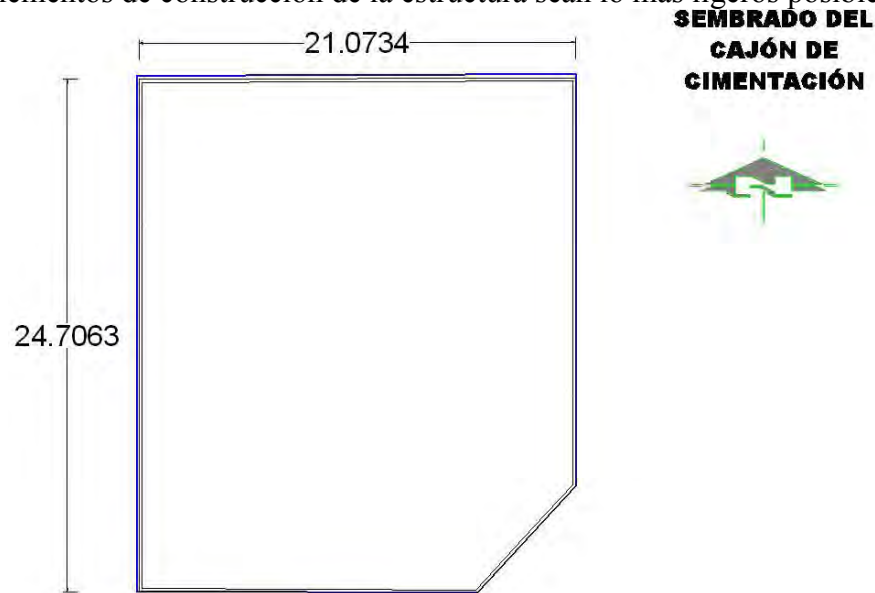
SEMBRADO DEL CAJÓN DE CIMENTACIÓN.
